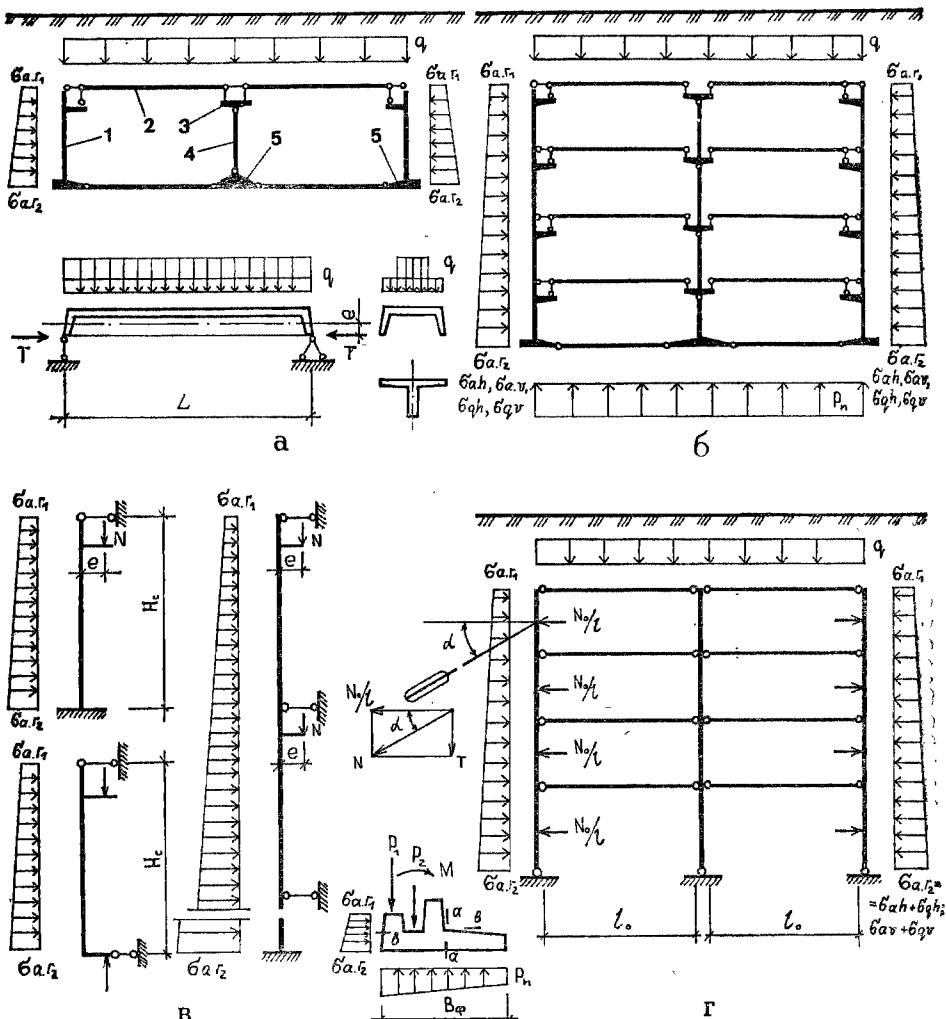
Расчетные схемы зданий, возводимых открытым способом:
